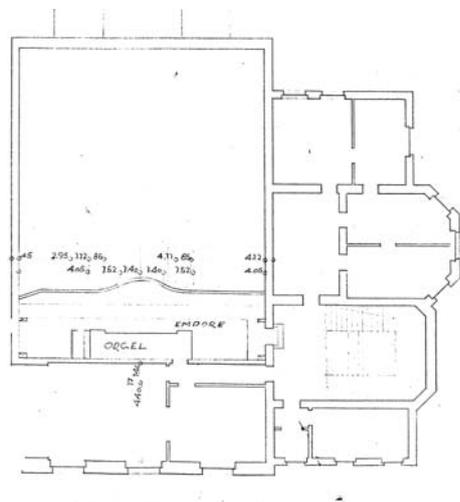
Grundriss Obergeschoss mit Orgelempore, Zustand 1960
